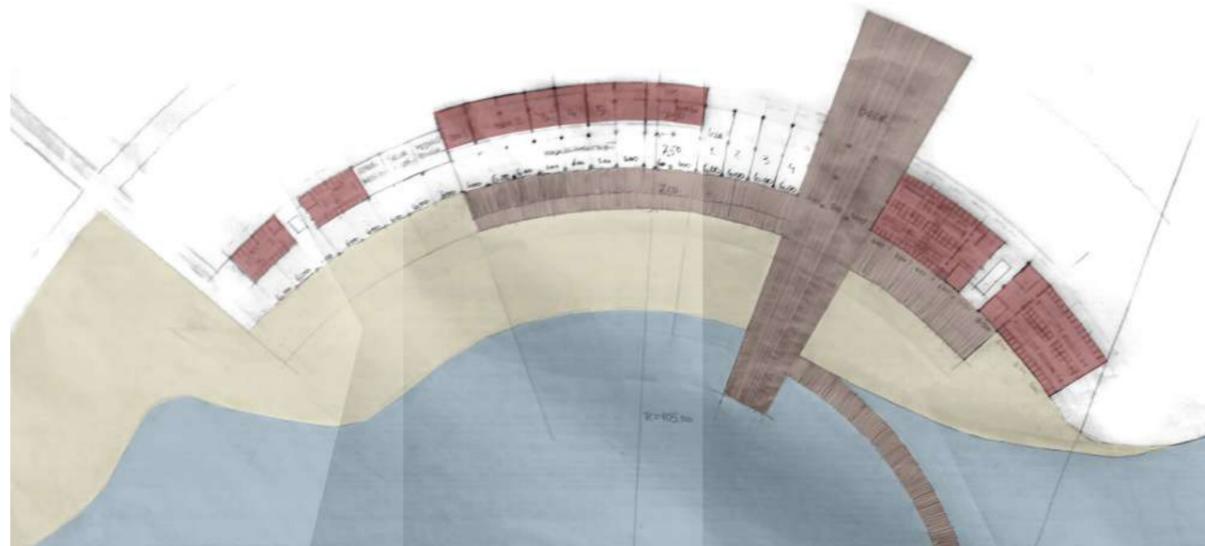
Croqui do Planta Balneário - Desenho Magnabosco, M. 2014-
